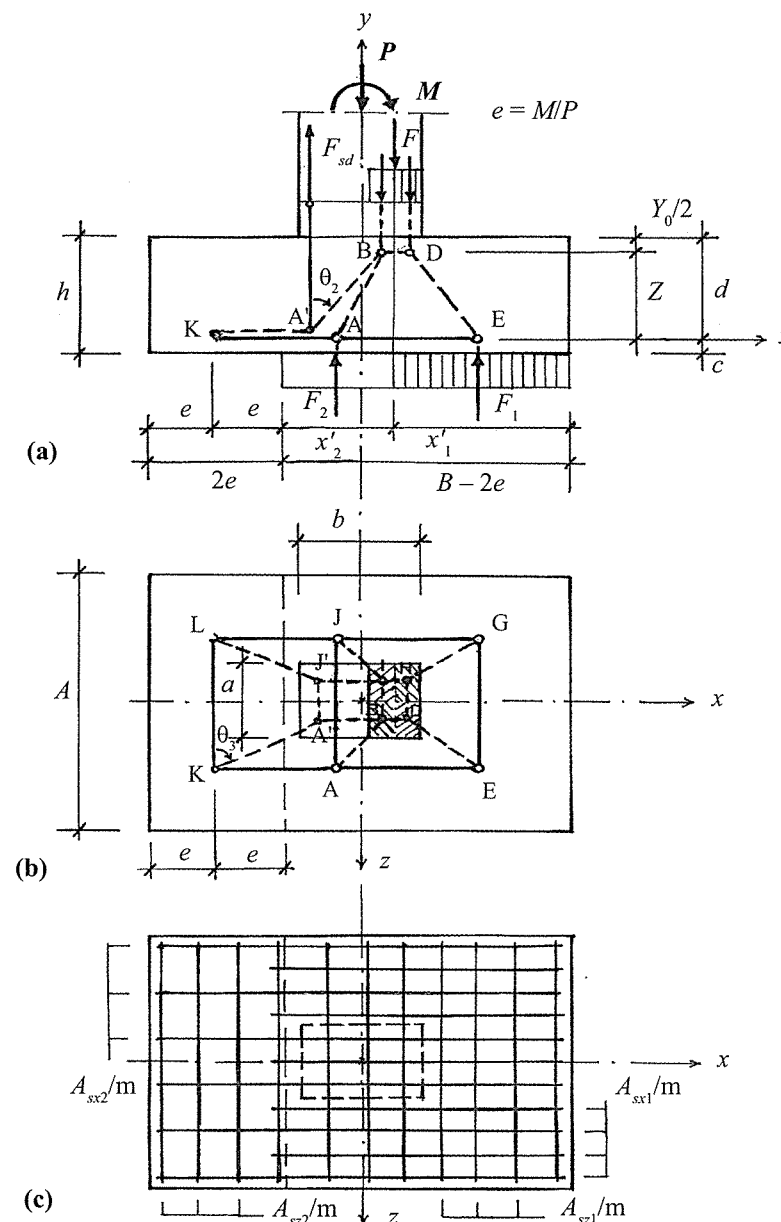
Modélisation B-T alternative pour une semelle rigide sous poteau en flexion composée (dans le plan xoy) de section partiellement comprimée avec aciers tendus ($e > B/6$):
